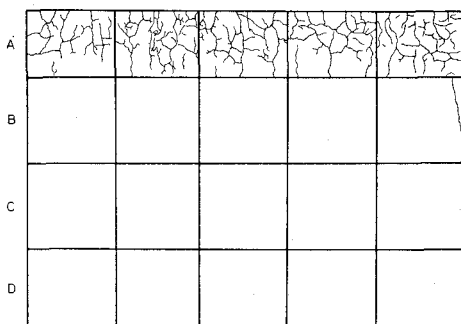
ひびわれ調査図(施工後4ヶ月)
